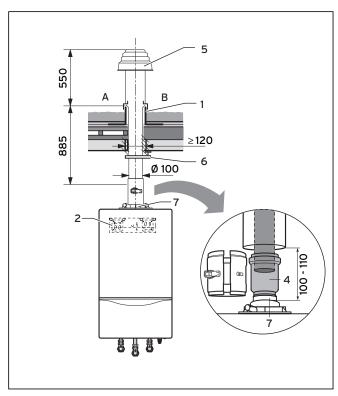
Пример монтажа вертикального кровельного ввода с разделительным устройством
